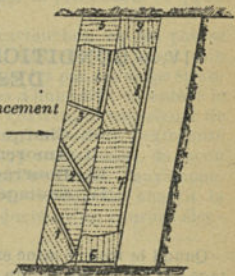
Banes très inclinés pris par le toit (coupe longitudinale).
